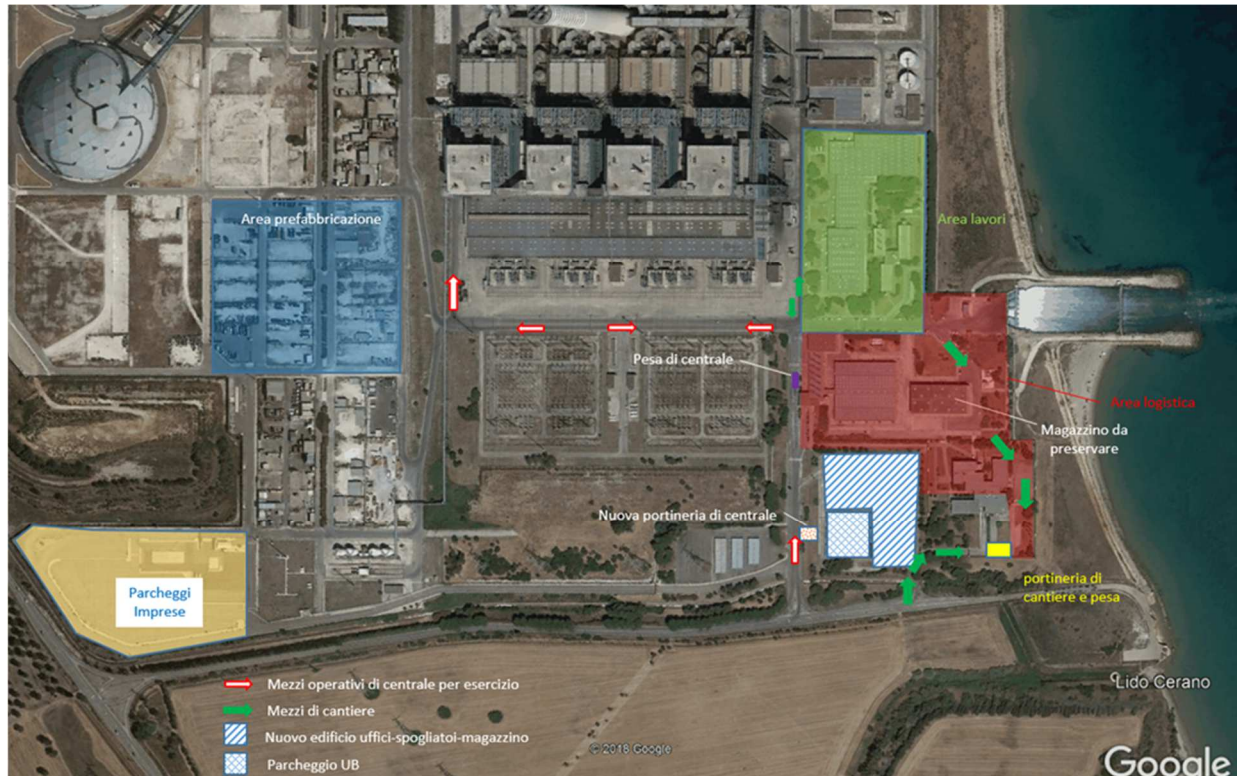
Rappresentazione delle aree di cantiere previste
